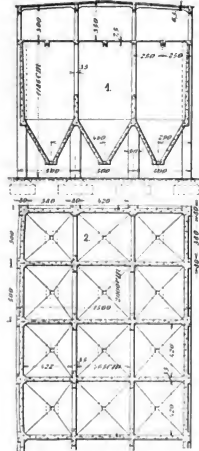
Z. A.: Die Exzentrischen-Bauten der Portland-Zementfabrik (Golzern i. Sa.).
